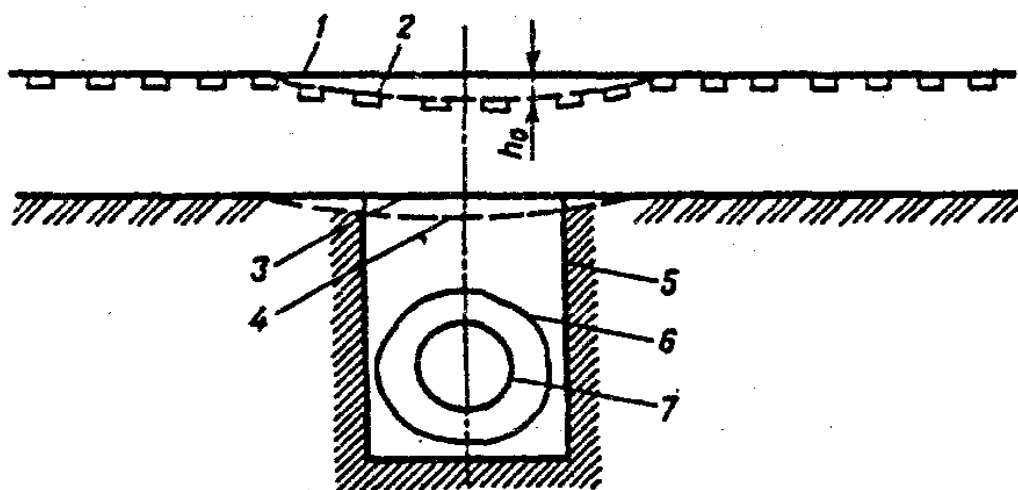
Осадки основной площадки земляного полотна над трубопроводными пересечениями:
